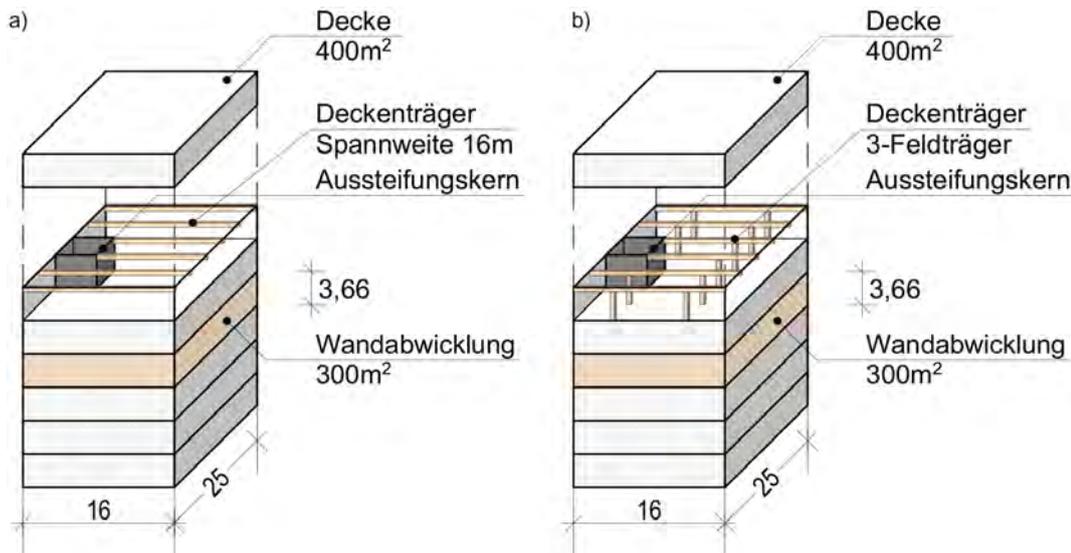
Statische Gebäudegrundformen kreislaueffektiven Bauens (schematische Darstellung): a) freier Grundriss/Einraumsystem als z. B. Aufstockung eines Gebäudebestands, b) Skelettbau als z. B. mehrgeschossiger Neubau
